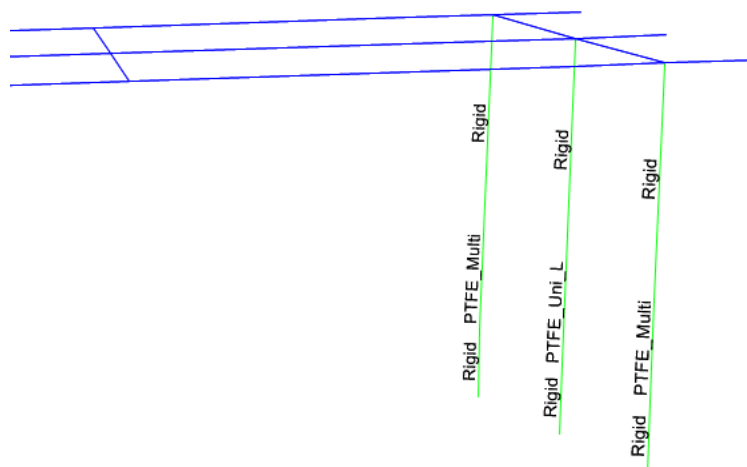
Modellazione connessioni tra travi e appoggi prima di modellare la spalla B
